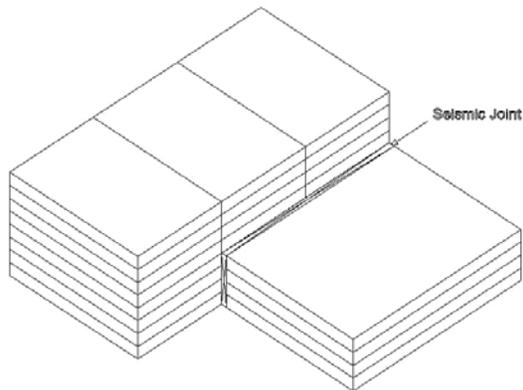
Bentuk-bentuk struktur bangunan yang tidak beraturan
